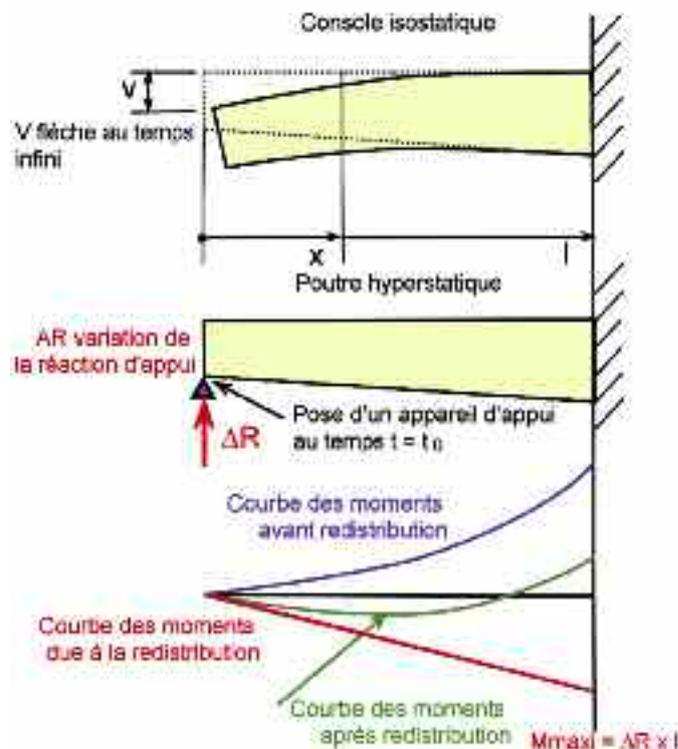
effets des déformations différées gênées dans une console rendue hyperstatique par la mise en place d'un appui
